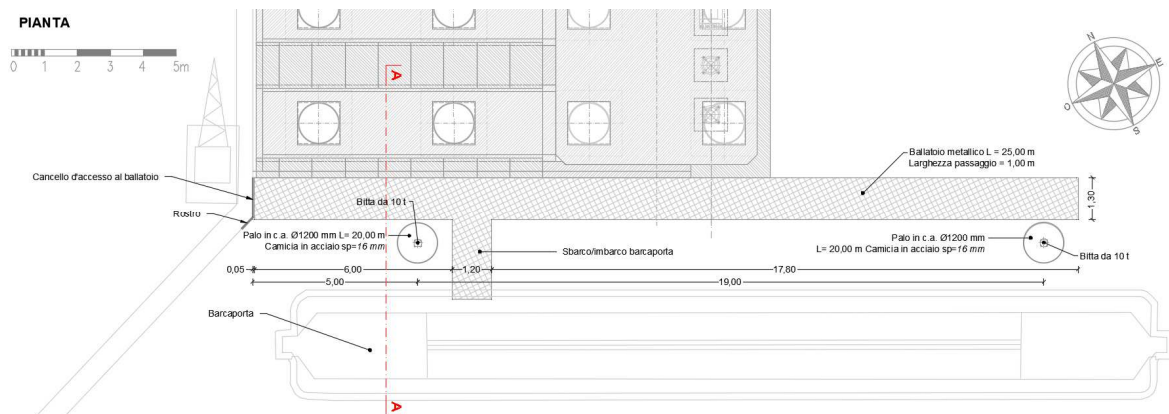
Sistema di ormeggio della barca-porta: Pianta
